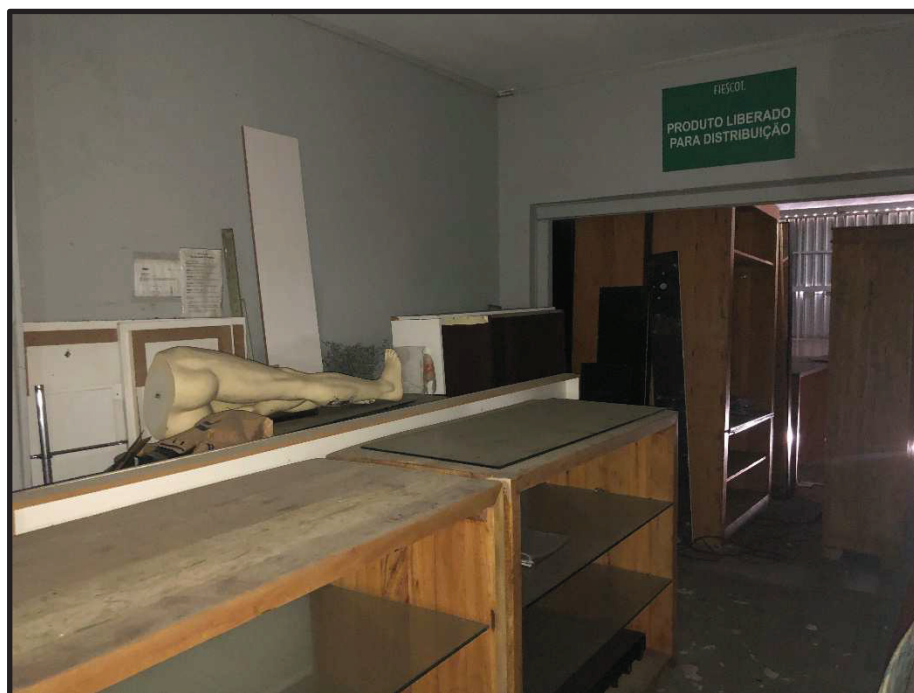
Pavimento Térreo – Sala 1 – Vista 2
